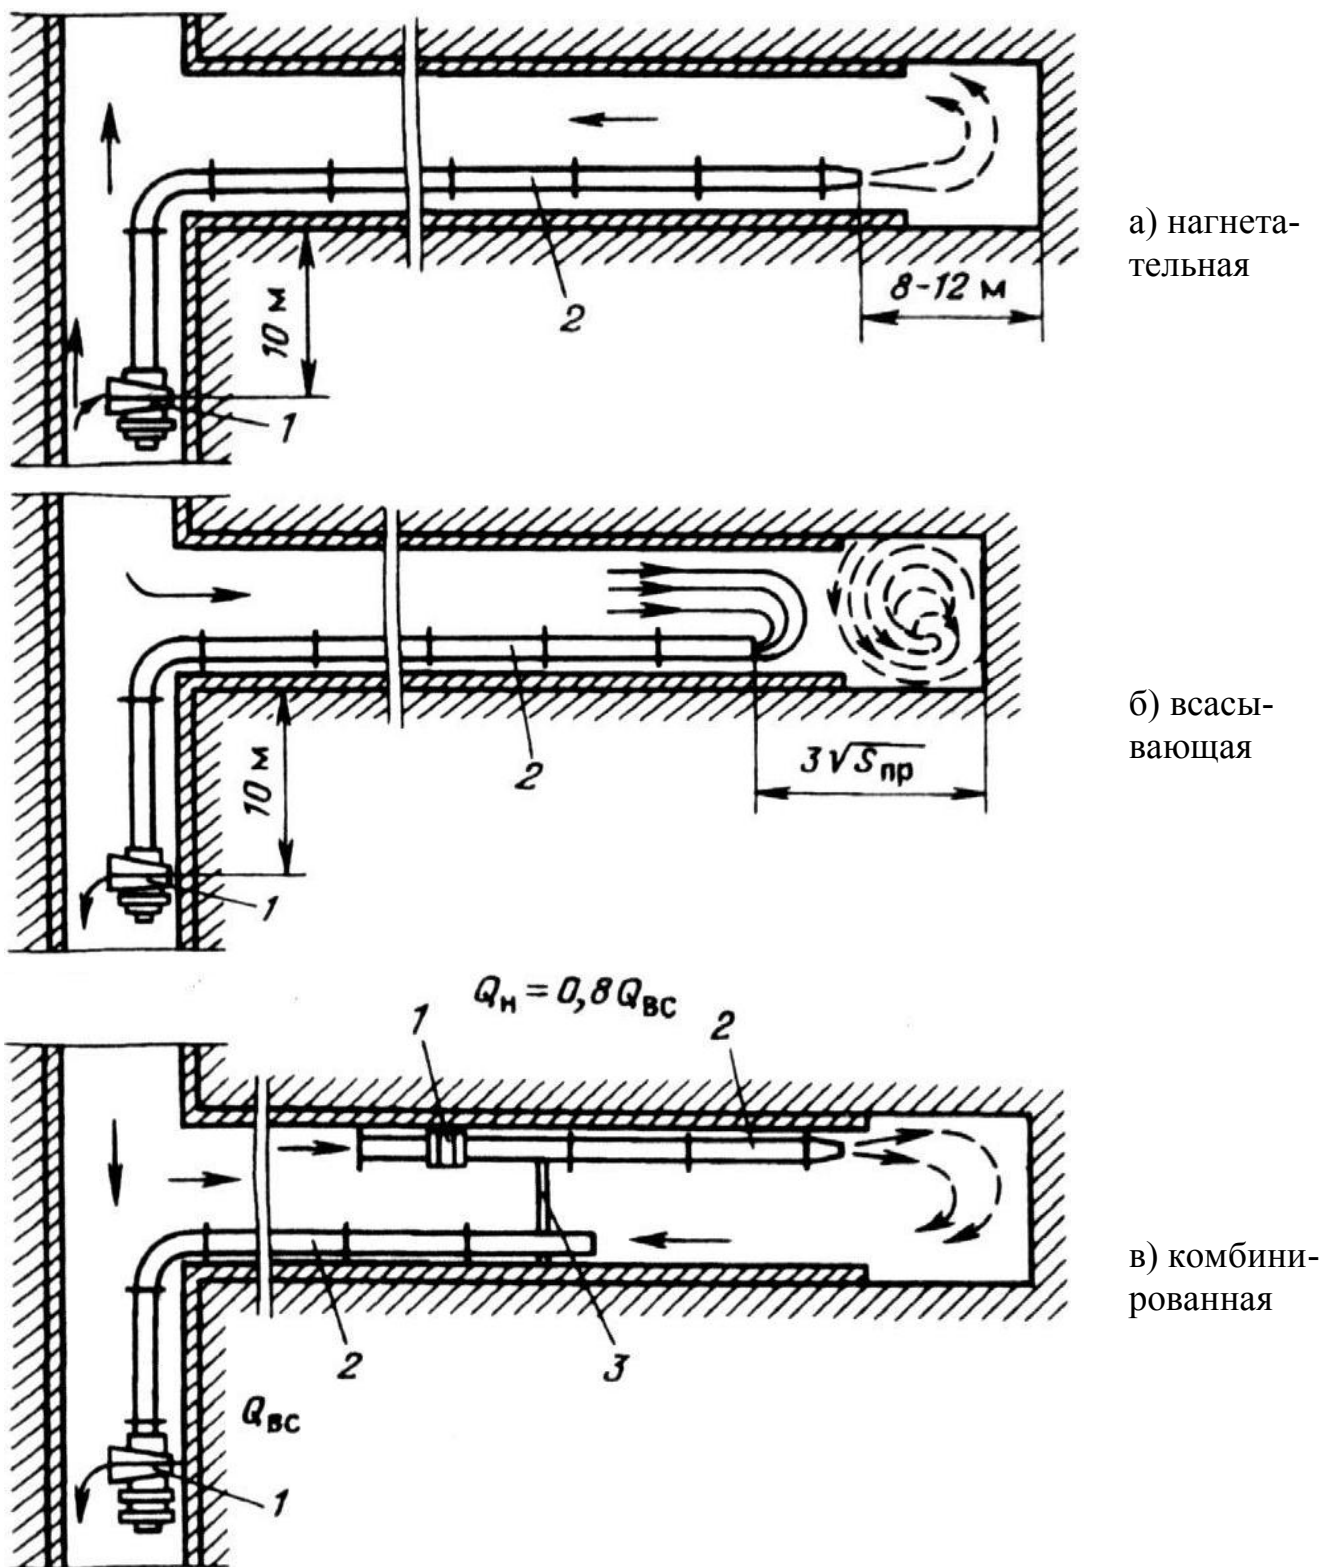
Схемы проветривания тупиковых выработок: 1 – вентилятор местного проветривания; 2 – вентиляционный трубопровод; 3 – вентиляционная перемычка.
